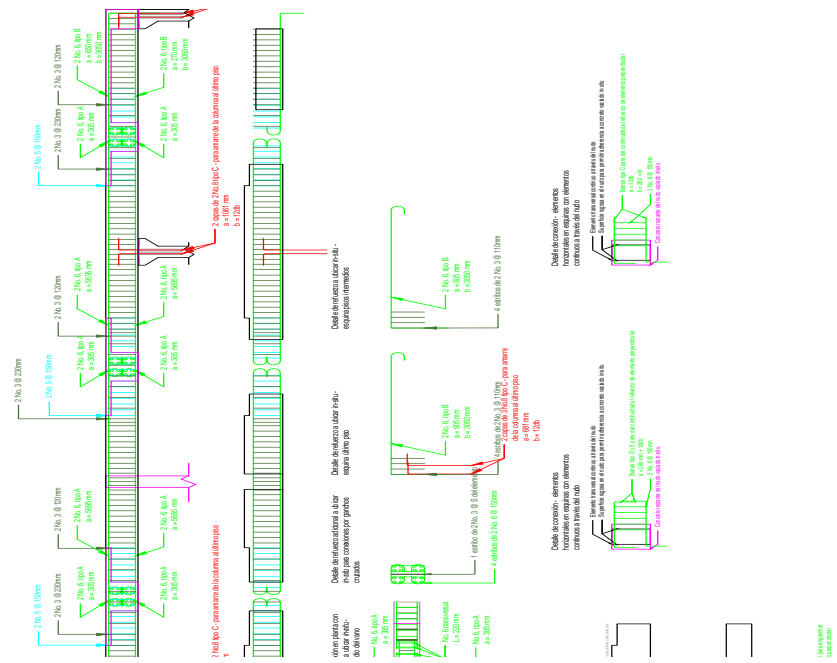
Despiece y detalle de conexiones para las vigas, edificación de altura media. Nota: en magenta se presenta el concreto vaciado *in-situ*.
